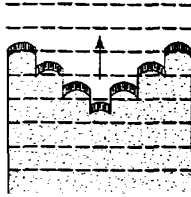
Строительство насыпи с формированием U-образного фронта работ
